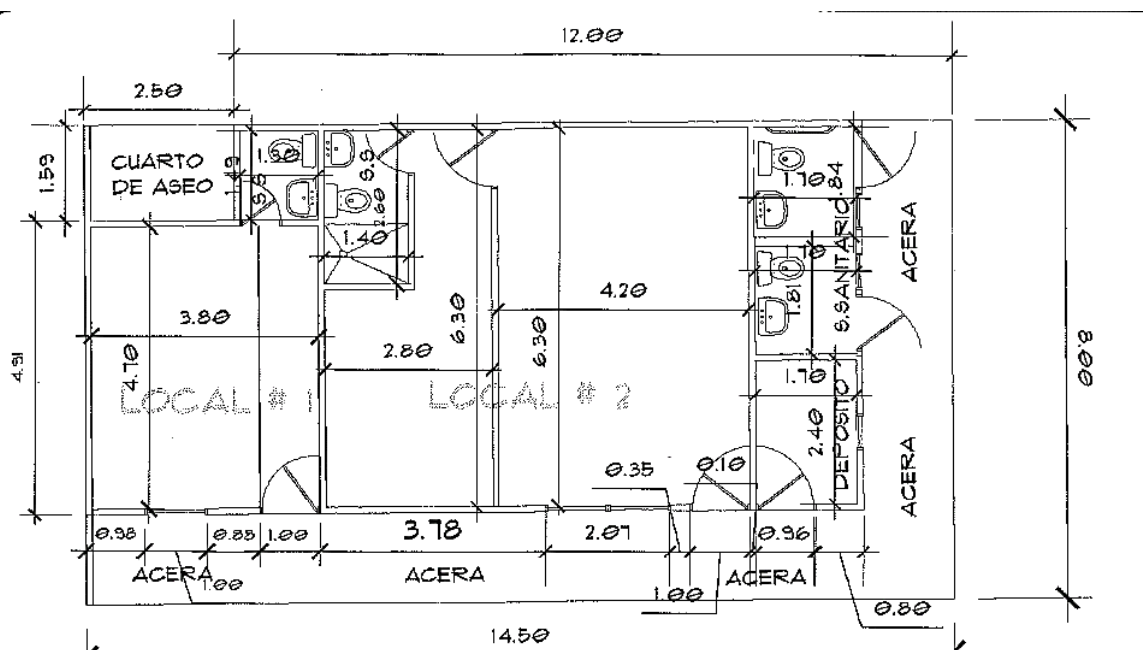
Planta arquitectónica local comercial y oficina administrativa
